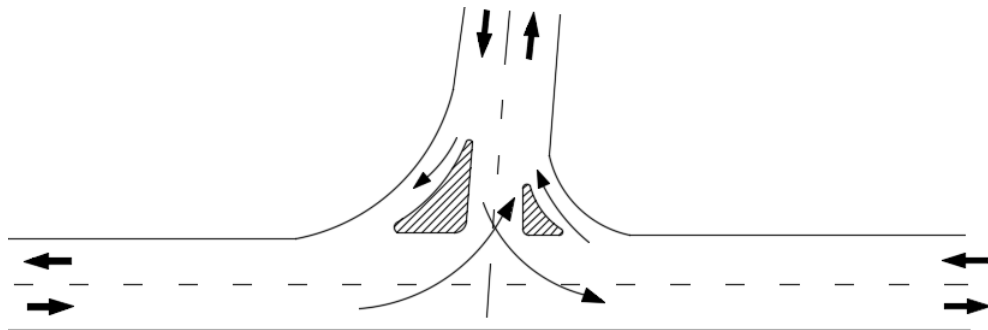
Intersecciones tipo "T" canalizadas
